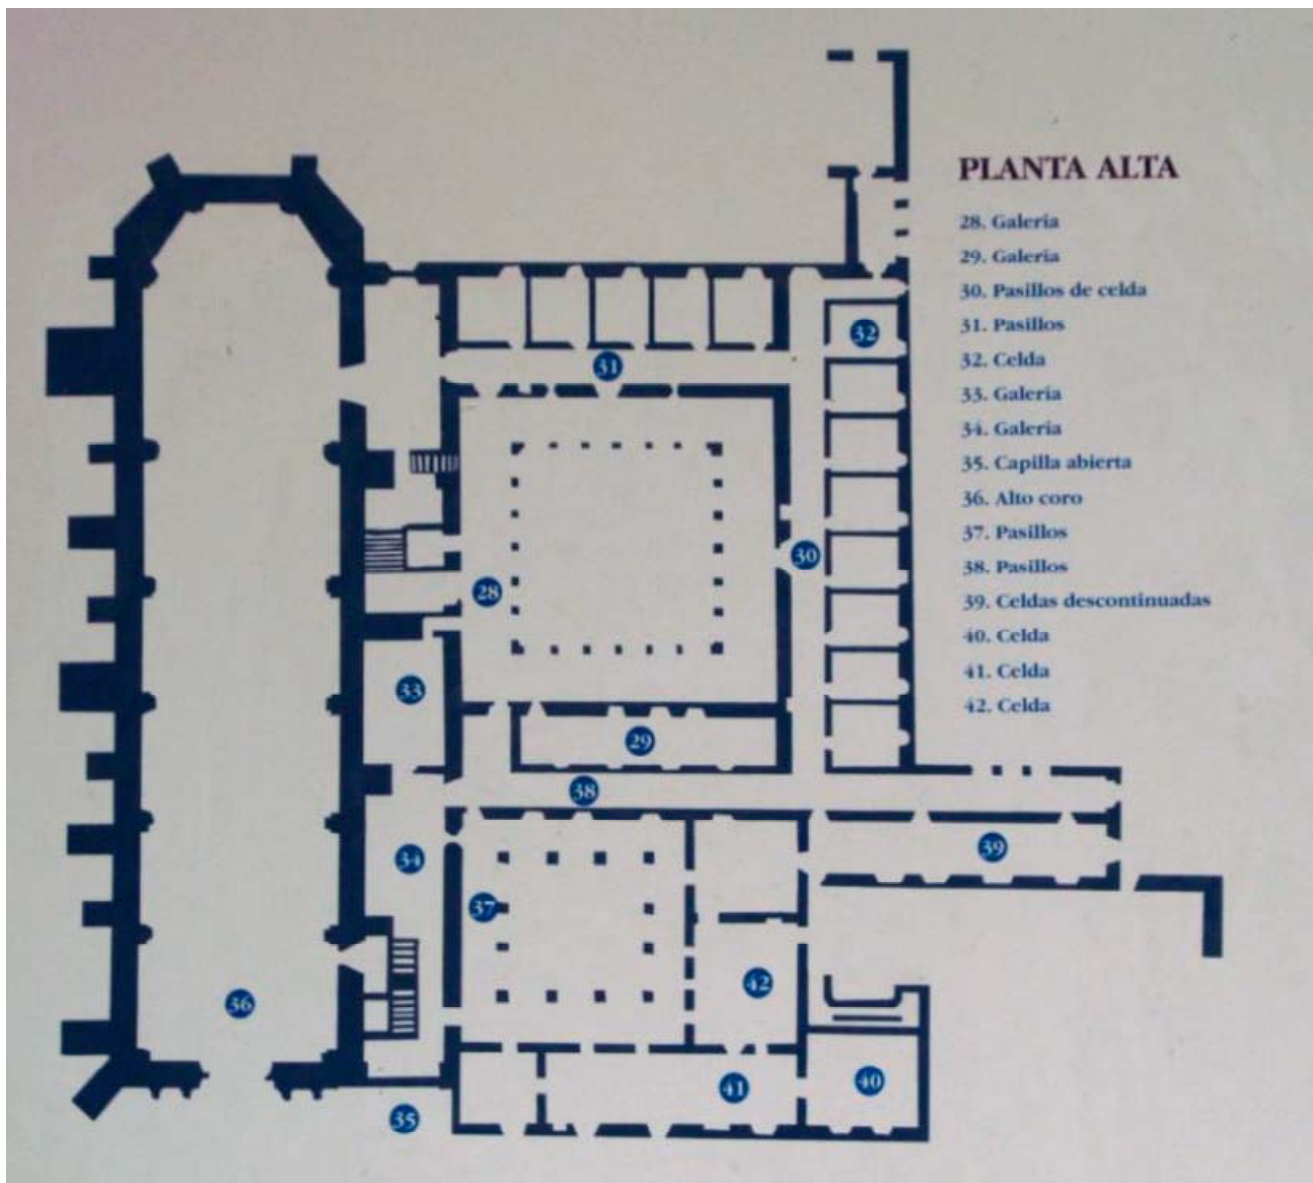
Plano de la planta alta de San Agustín Acolman.
